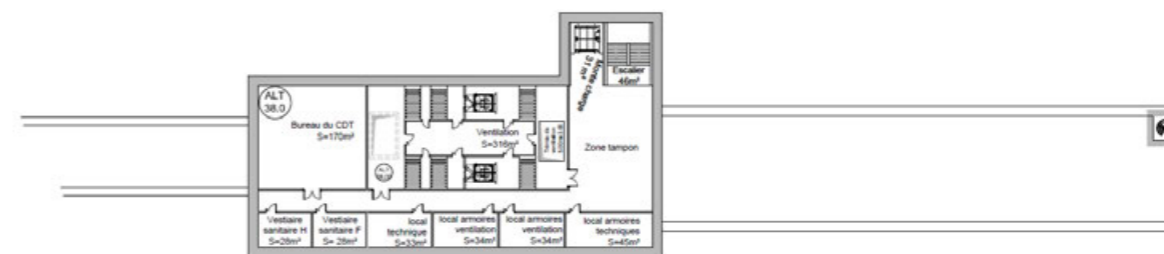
Plan du niveau supérieur du CDT (Source RATP)
